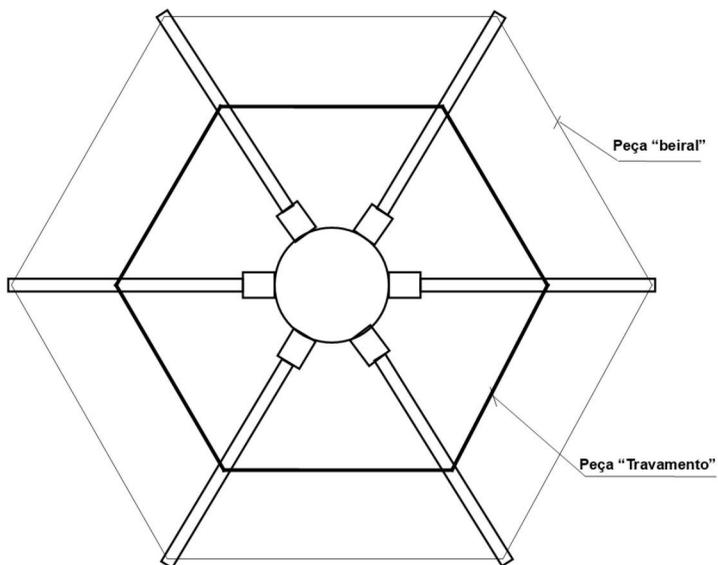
Estrutura da cobertura da barraca vista de cima.
